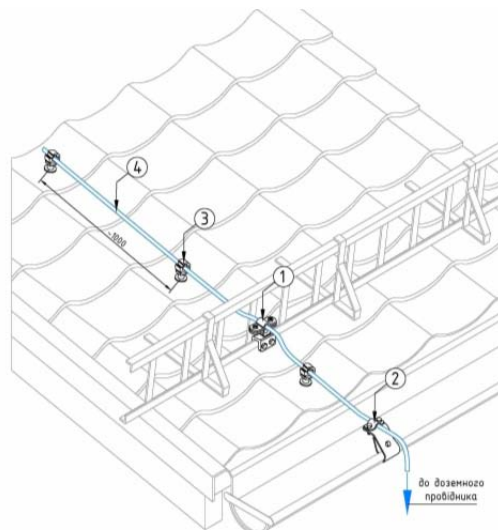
Схема з'єднання систем зовнішнього блискавкозахисту з металоконструкціями будівлі
